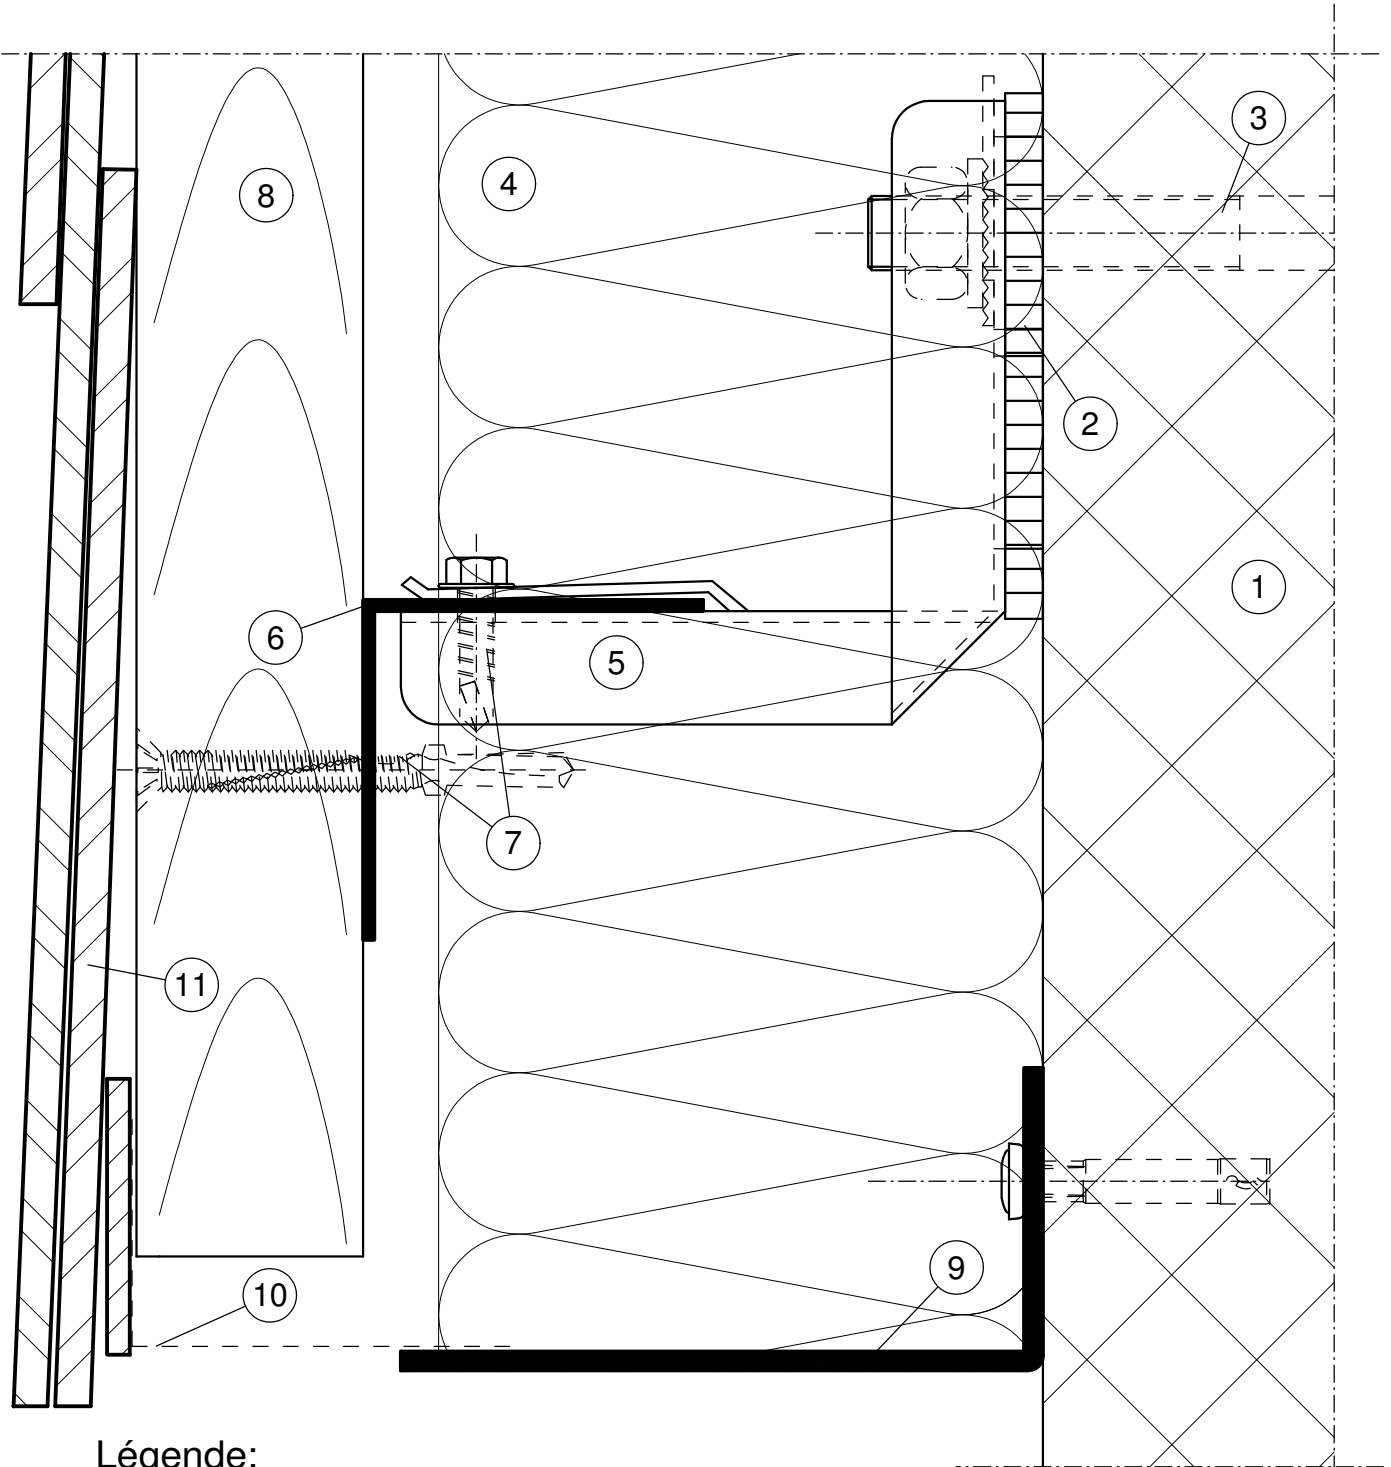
DETAIL DU SOCLE, COUPE VERTICALE Système WSK
